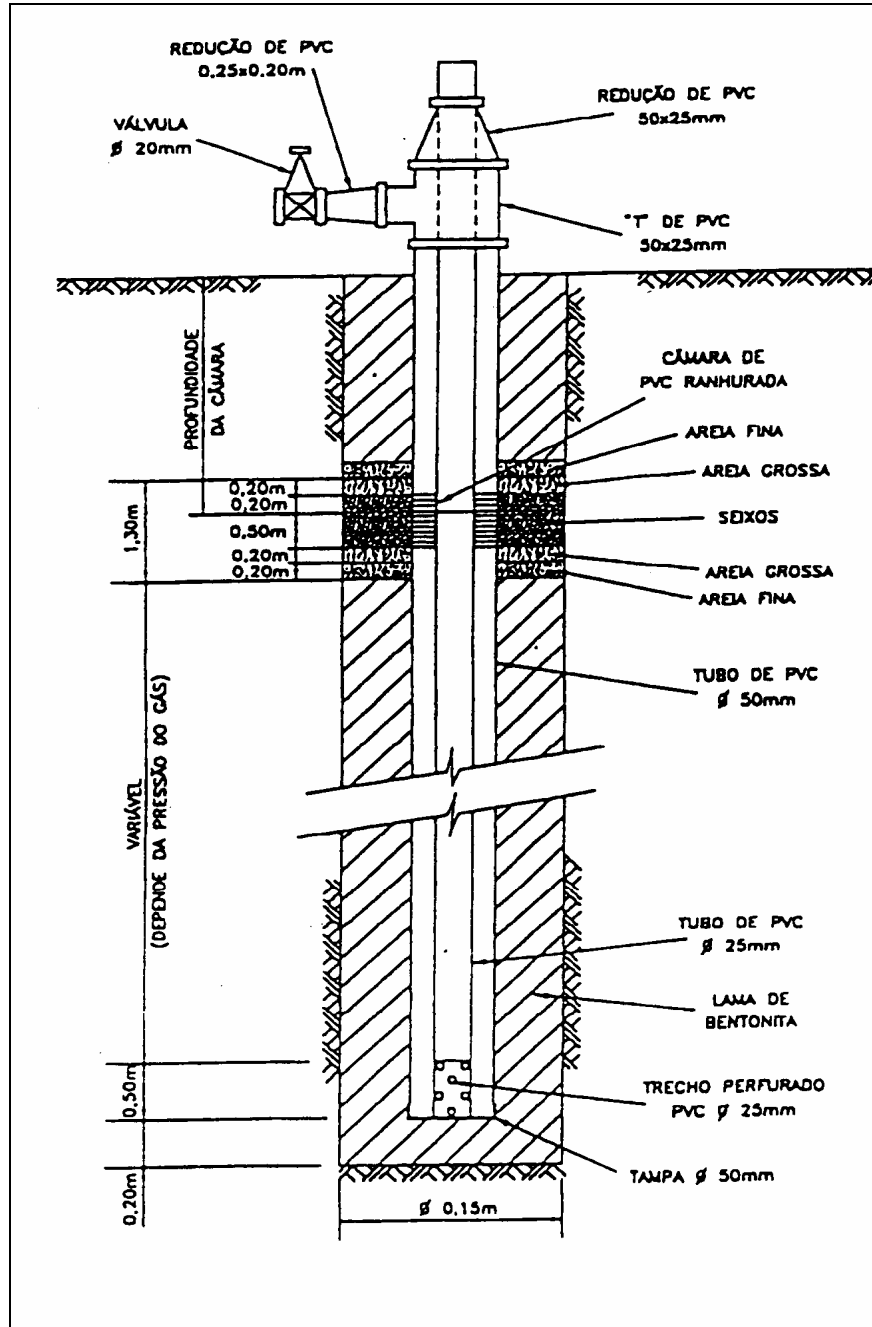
Detalhes Construtivos do Piezômetro
